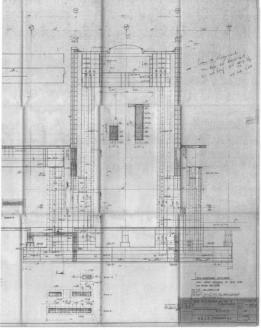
Sección constructiva perteneciente al juego de planos de la ingeniería Corsmit, con fecha 27/08/1968 (© Aldo van Eyck Archive)
